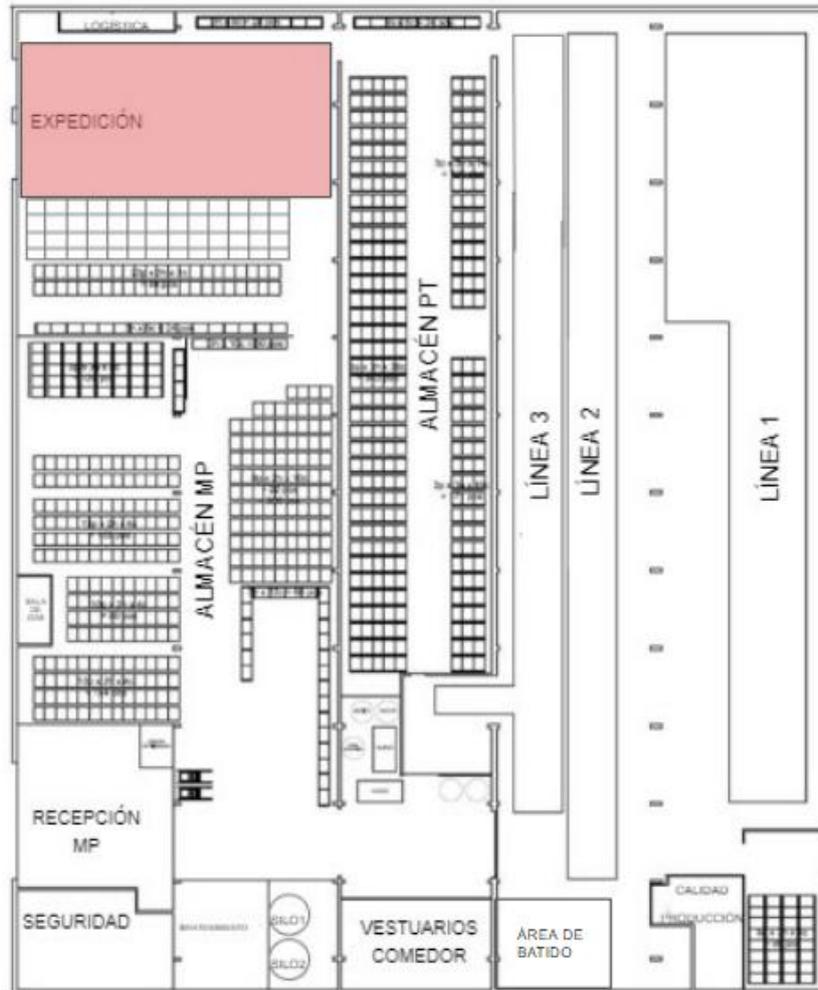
Layout de la planta con área de expedición sombreada en rojo
